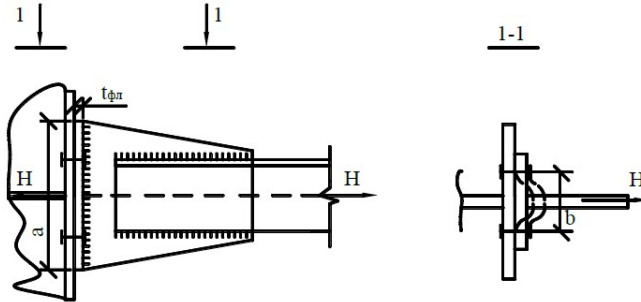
Фланец верхнего пояса при жестком сопряжении фермы с колонной
